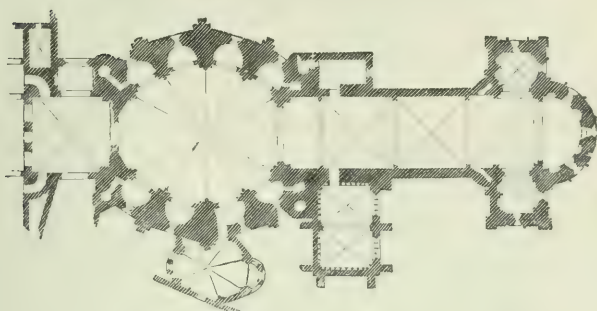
St. Gerion zu Köln. Grundriß. S. 58.
